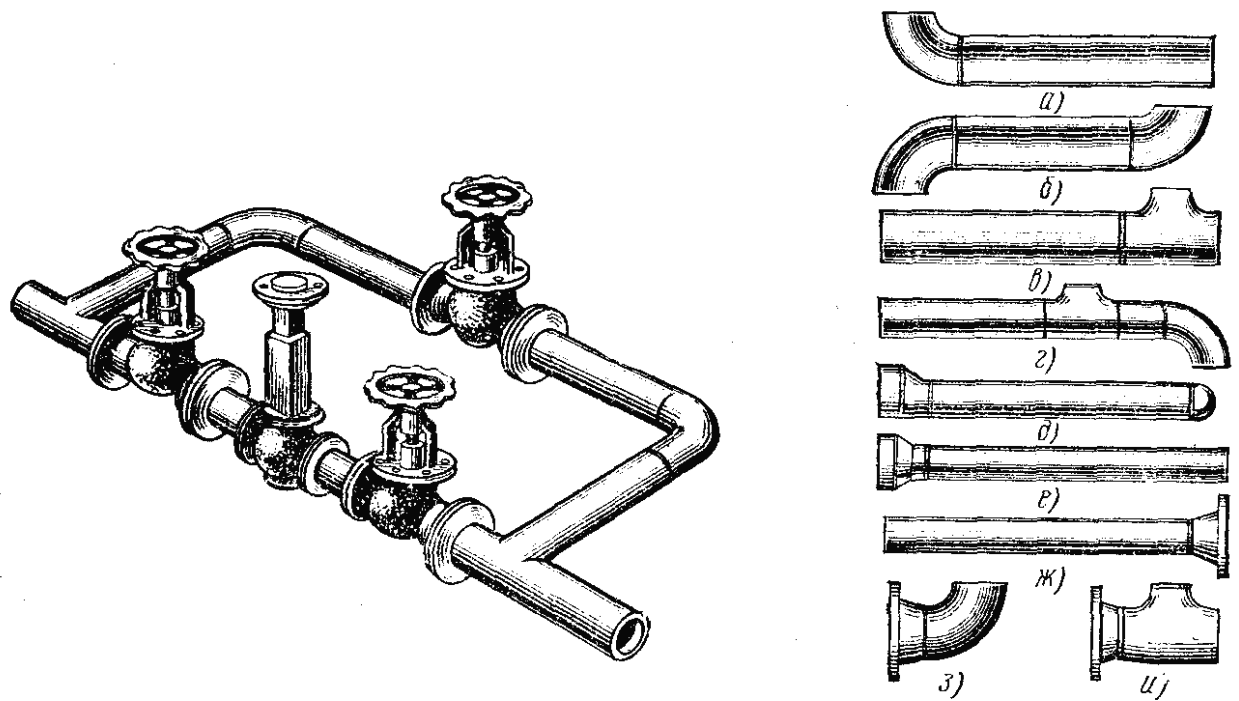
Узел трубопровода и элементы трубопроводов:
